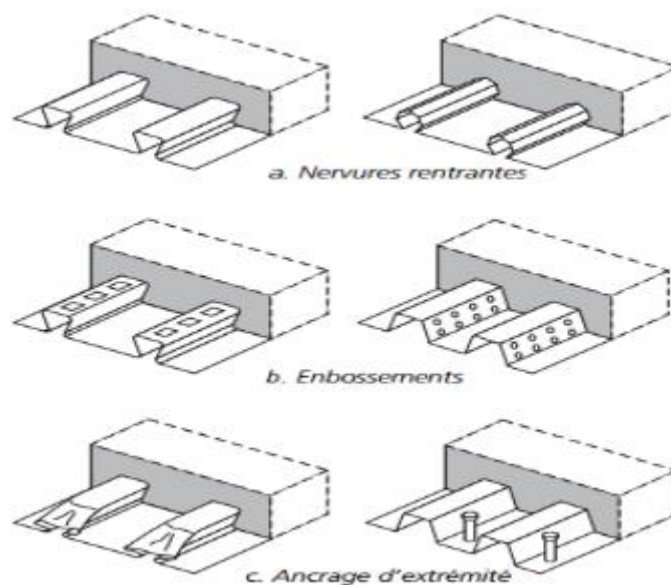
formes typiques de liaisons dans les dalles mixtes
